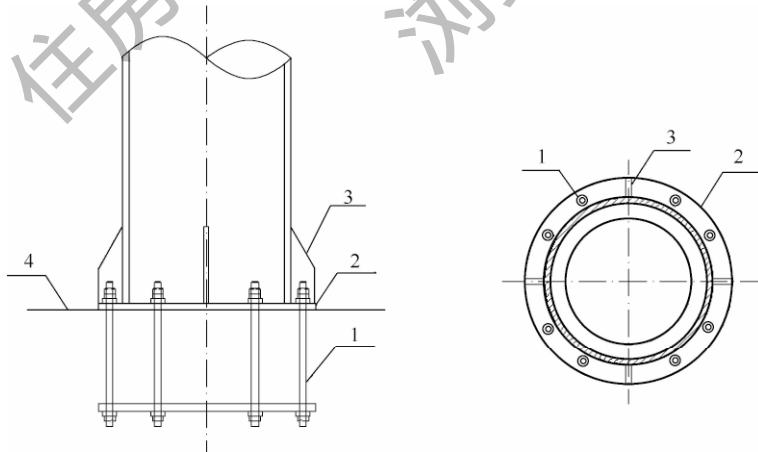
圆形钢管混凝土柱非埋入式柱脚
